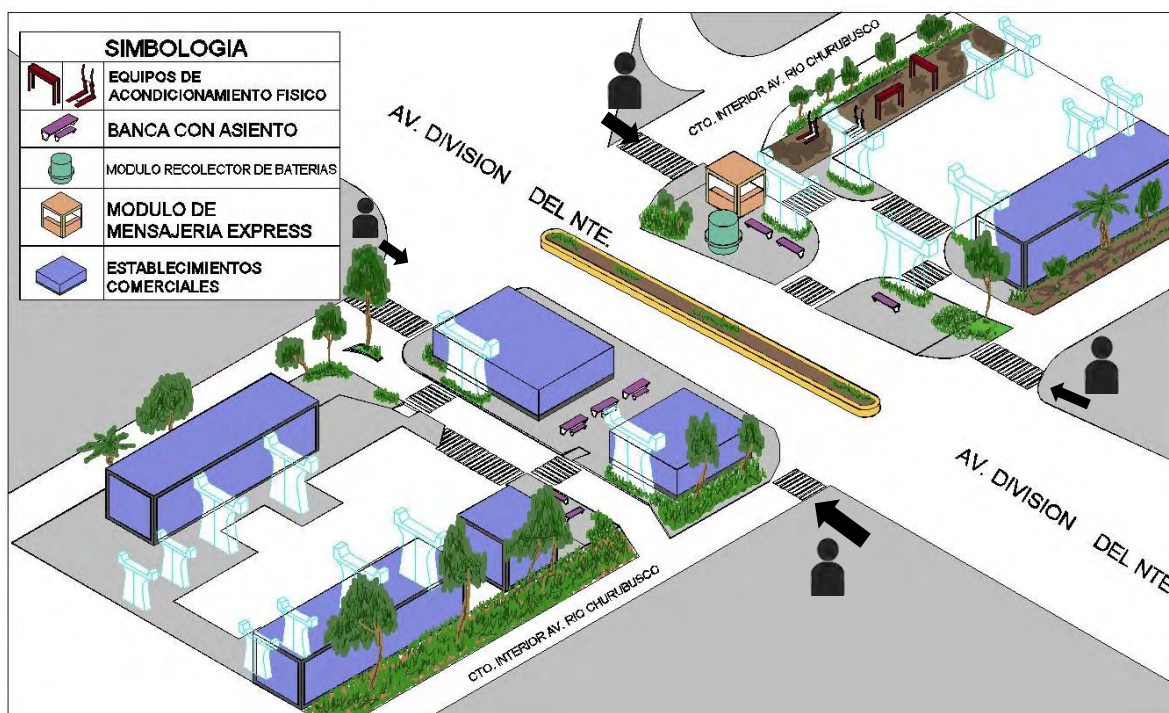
Diagrama del Bajo Puente Div. del Norte (México) Fuente: elaboración propia
